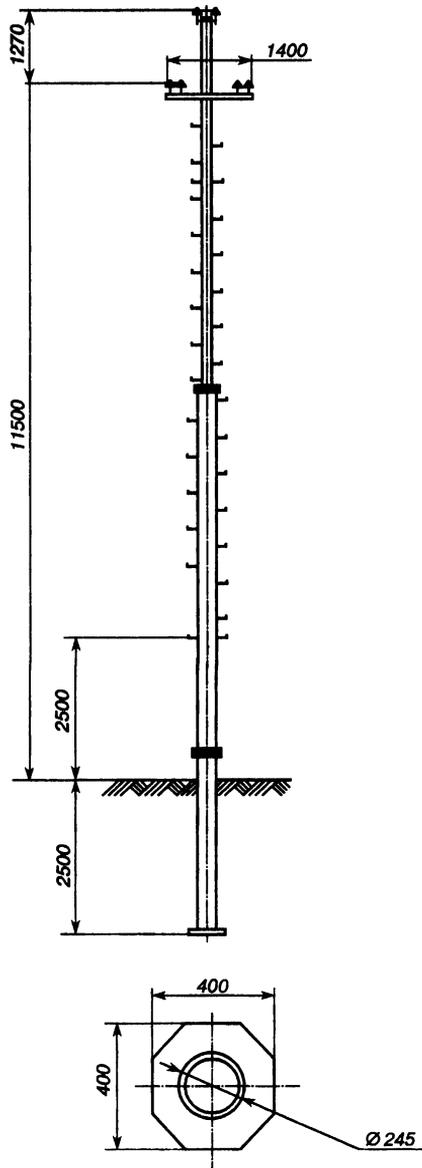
Переходная железобетонно-металлическая опора ВЛ 10 кВ
